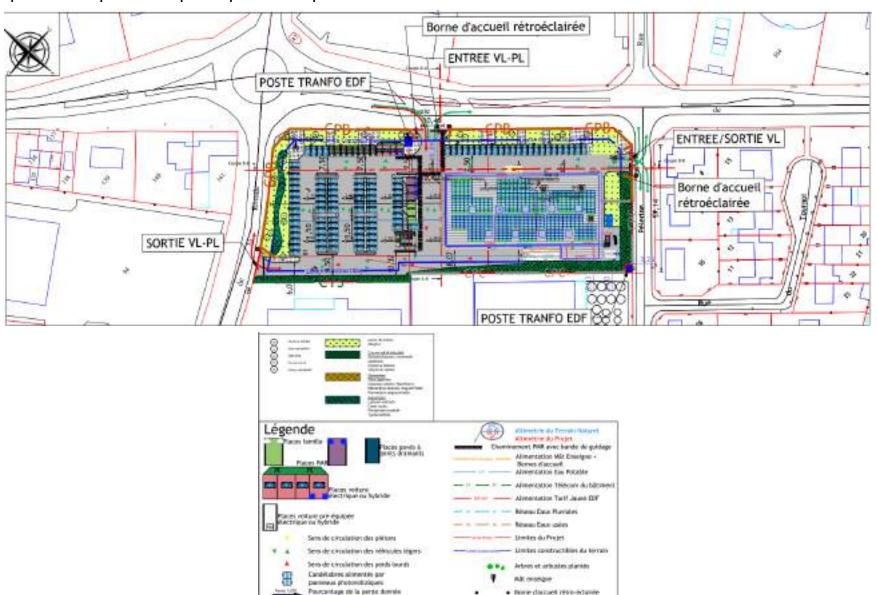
Plan masse du projet; Source: Villesange Masson Architecture
